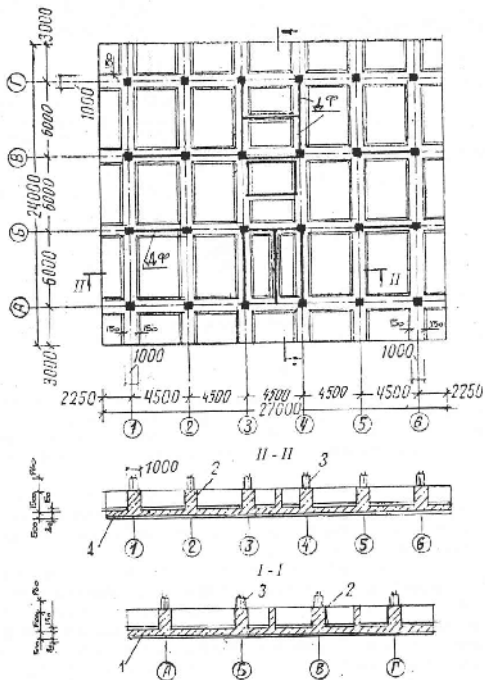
Пример плитного фундамента каркасного здания: 1 – сплошная железобетонная плита с ребрами вверх; 2 – ребра плиты; 3 – колонны; ДФ – диафрагмы жесткости
